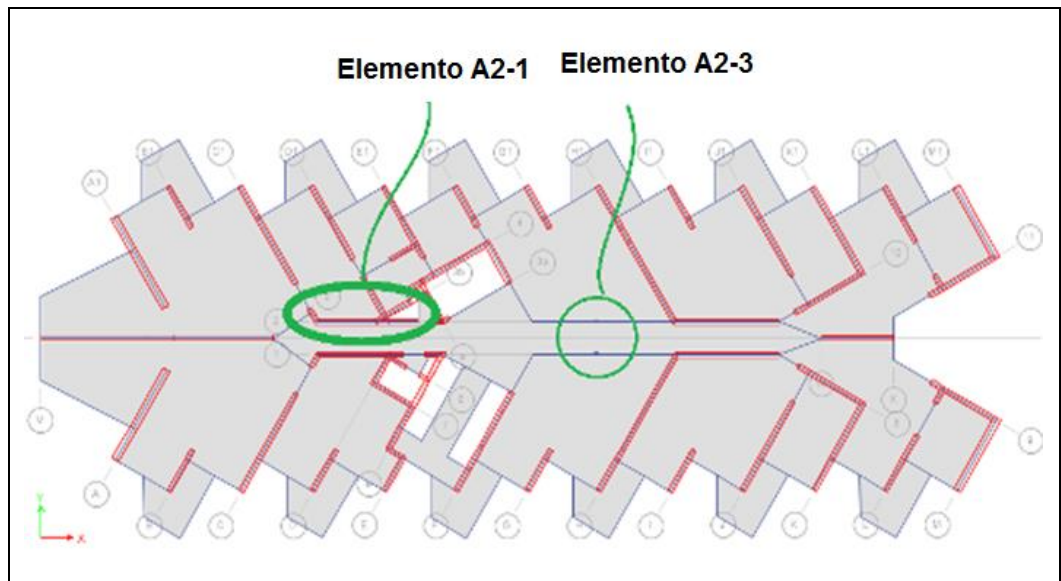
Planta piso 1 del edificio A2, se indican zonas y elementos dañados
